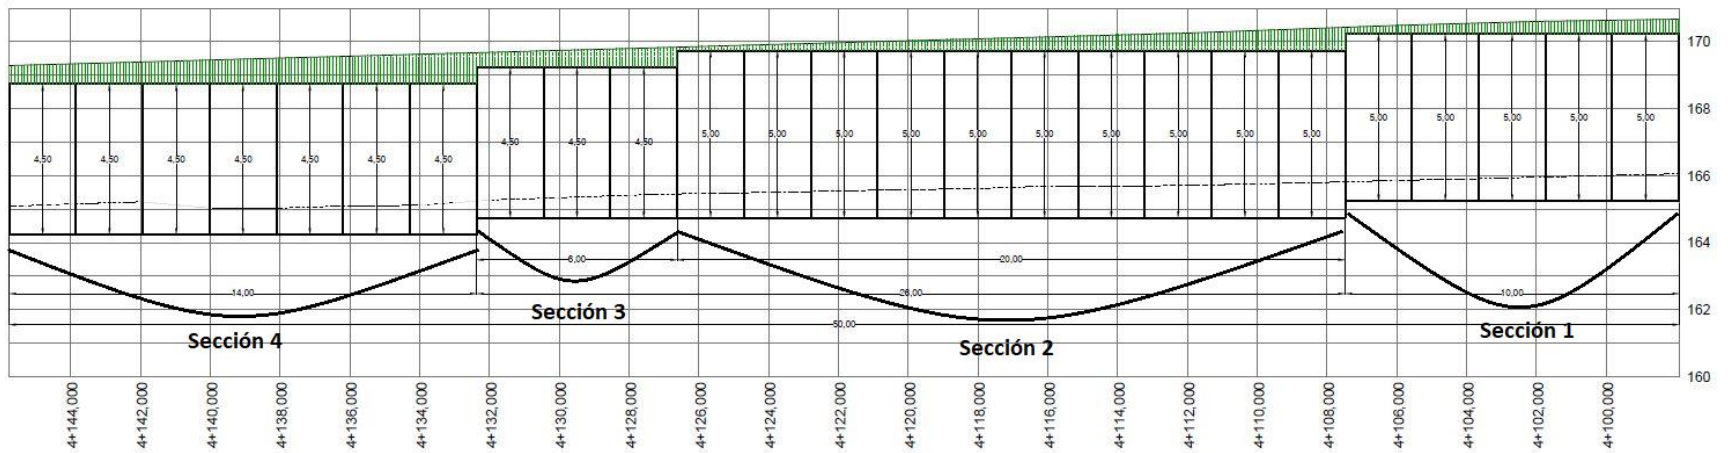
Vista frontal del muro de gaviones de estudio en el kilómetro 4+100 dividida en secciones. (Maccaferri de Centroamérica.
